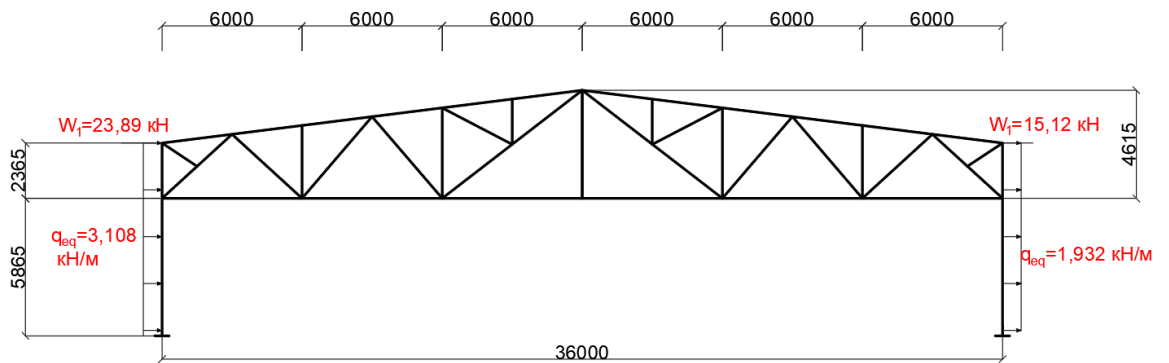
Схема загрузки рамы ветровой нагрузкой
